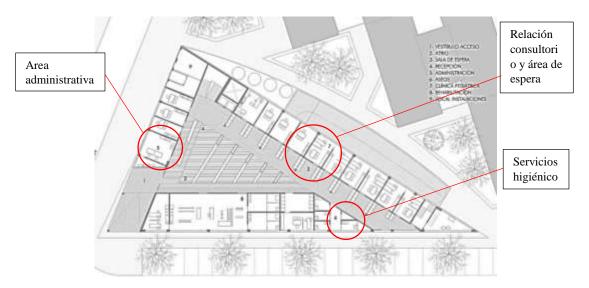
Planta baja Adaptado de (Fernando Alda, 2010)
